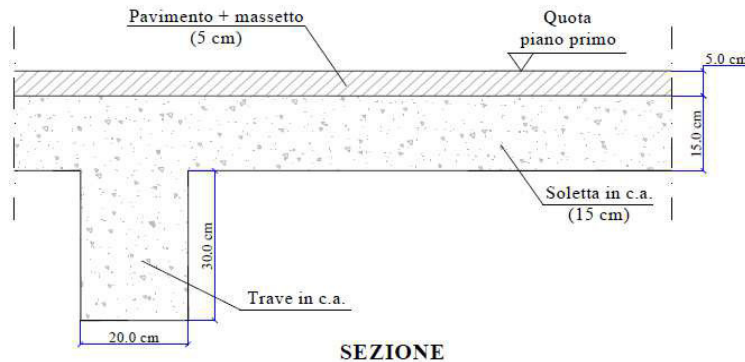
Tipologia di solaio individuato (SS1 - saggio solaio piano primo).
